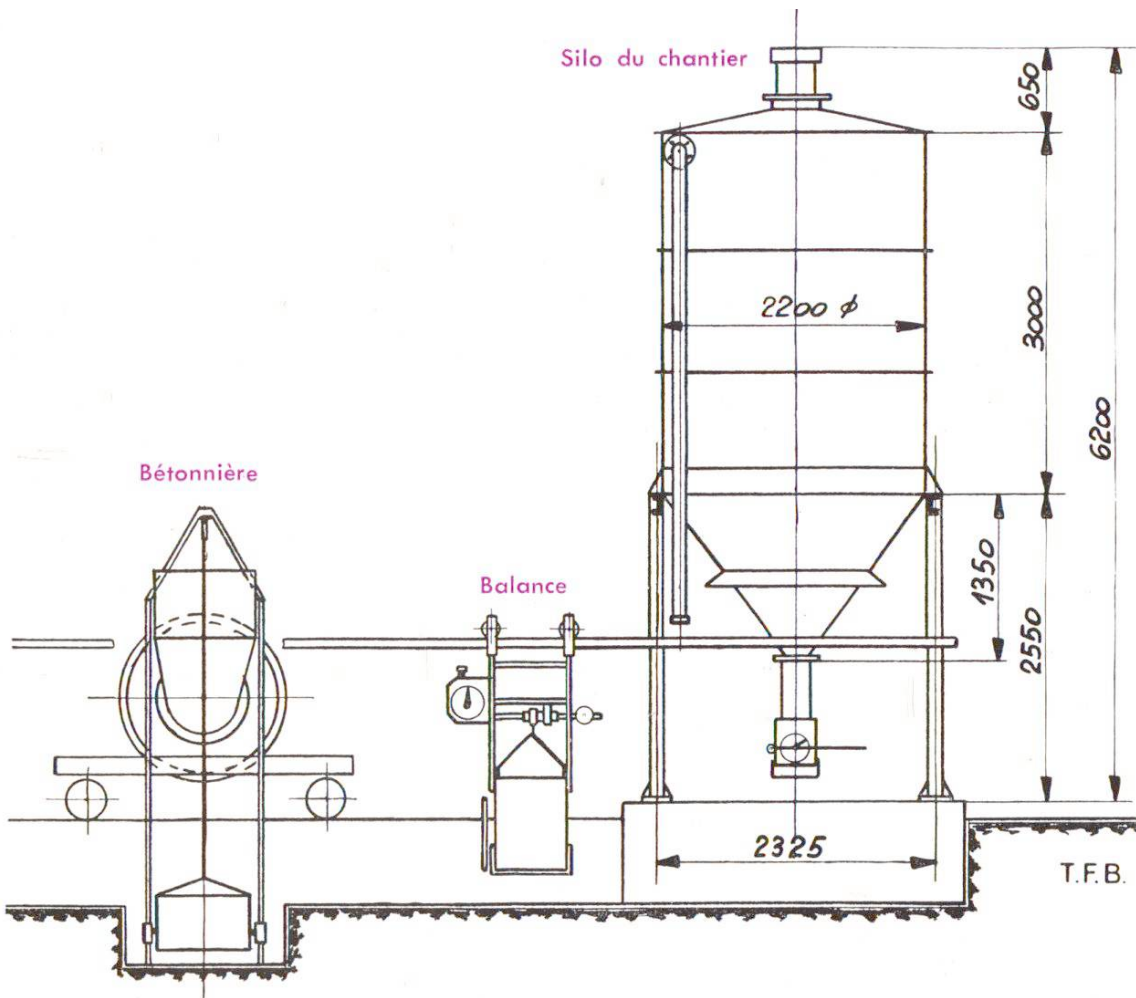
Installation du chantier pour ciment en vrac. Silo de 15 t
